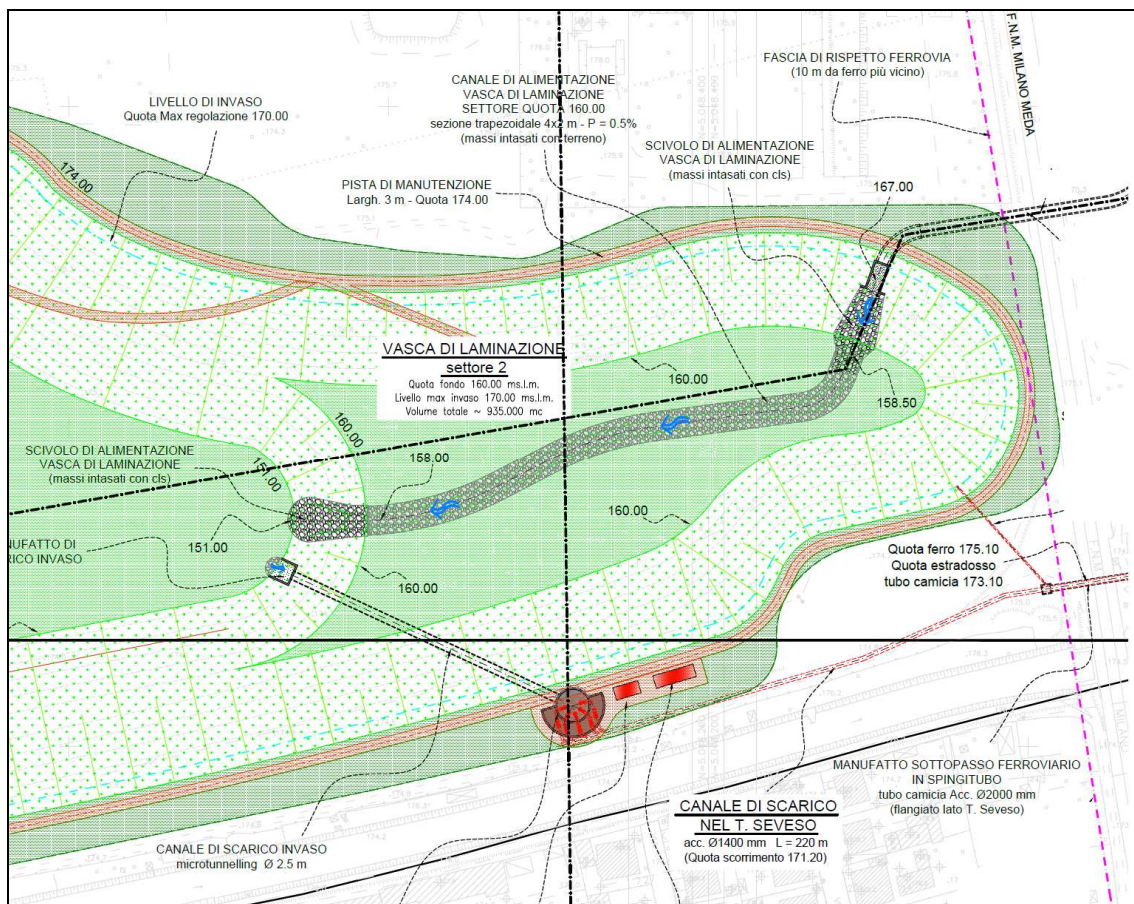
Stralcio della planimetria della vasca di laminazione di Paderno Dugnano con indicazione delle opere idrauliche di raccordo tra settore I e II
